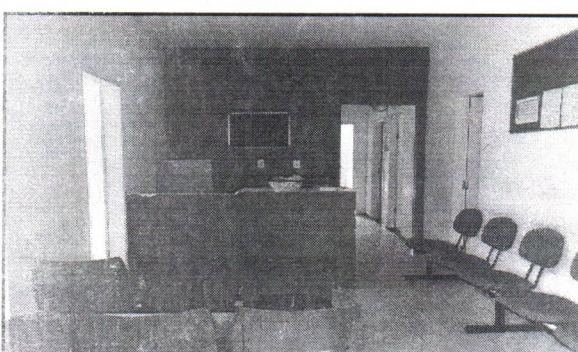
Imagem da área de Recepção, com piso cerâmico e forro em gesso
